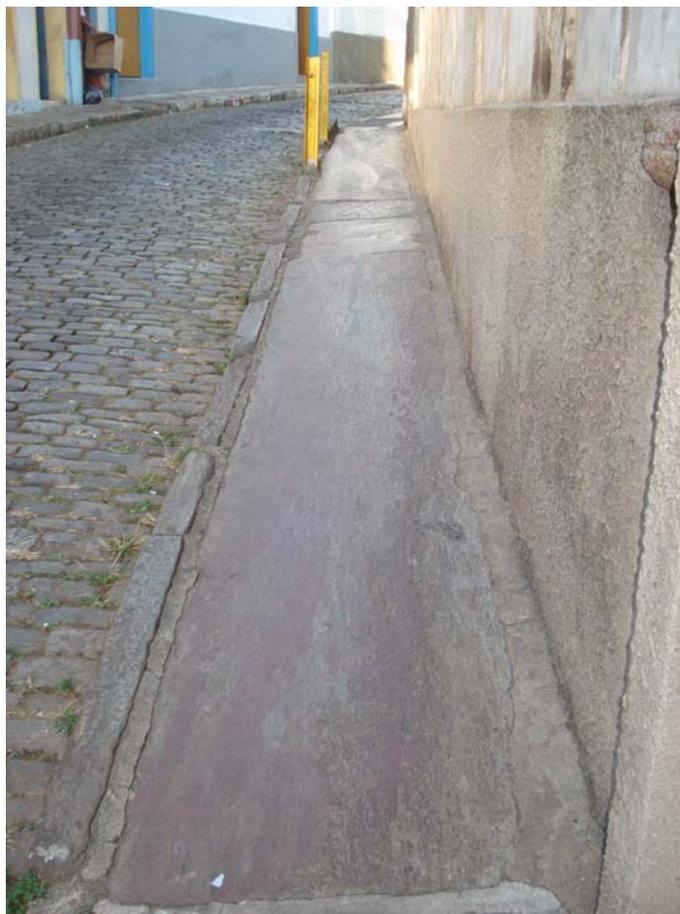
Rua São José, ressaltando a nova pavimentação – Bairro: Centro
